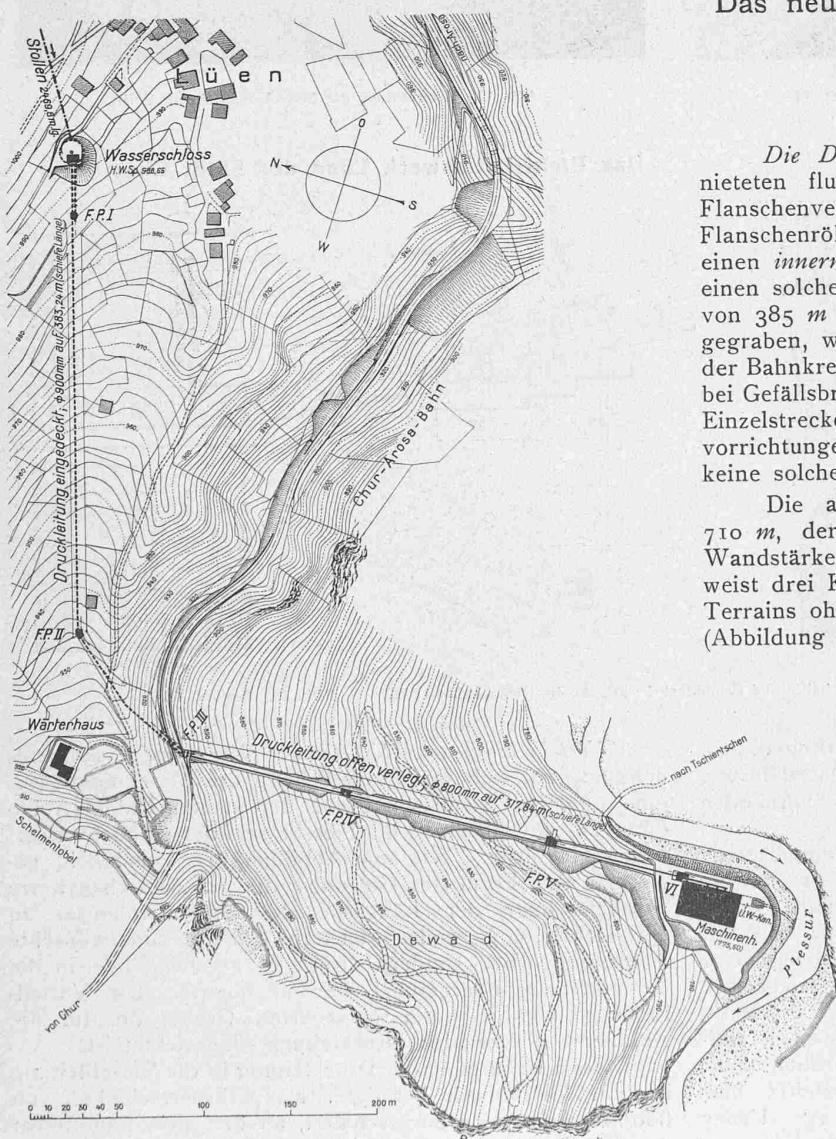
Wasserschloss, Druckleitung und Zentrale bei Lüen. — Lageplan 1:4000.
